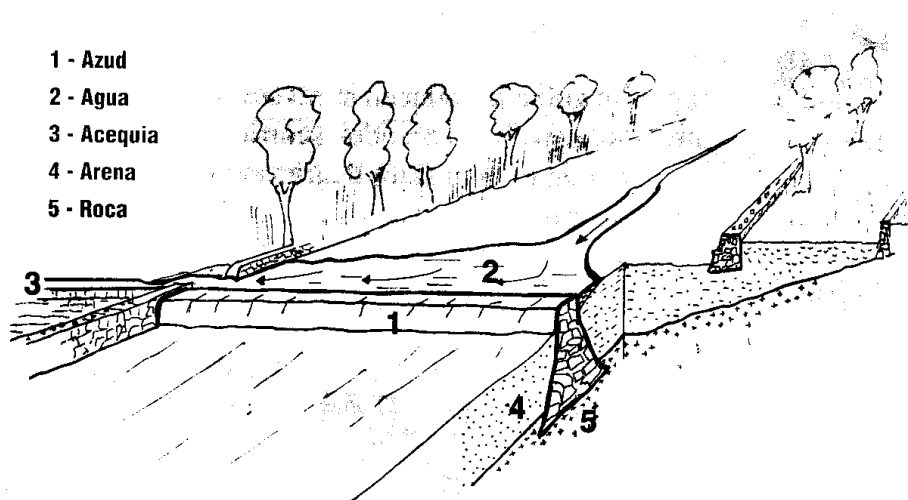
Detalle de un azud, con un esquema de las partes que lo forman.
